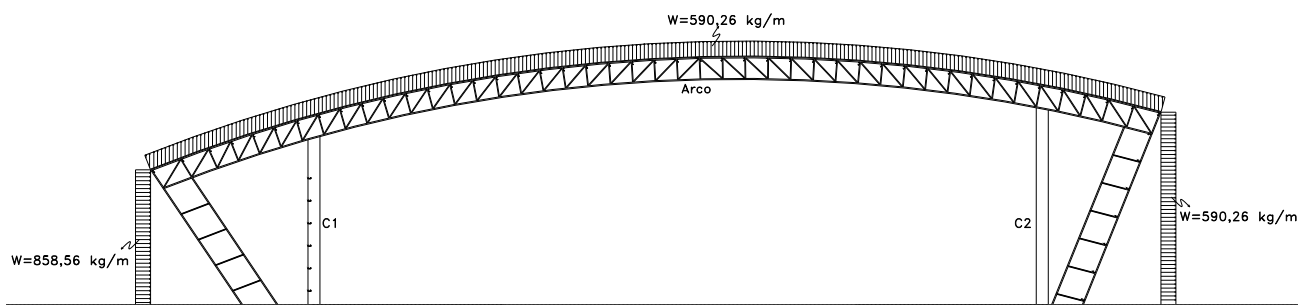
Pórtico metálico sometido a las acciones del viento
